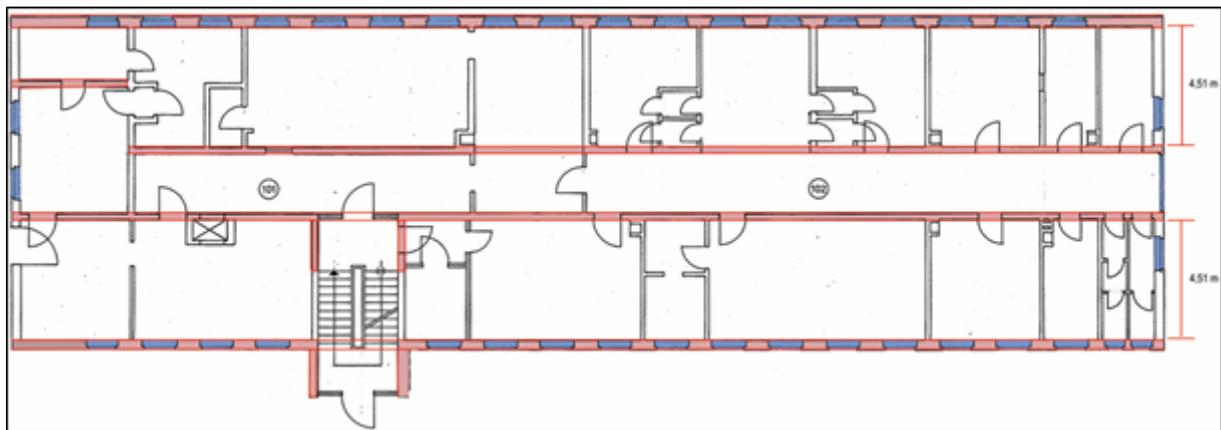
Grundriss Erdgeschoss ehemaliges BSZ von 1988.
